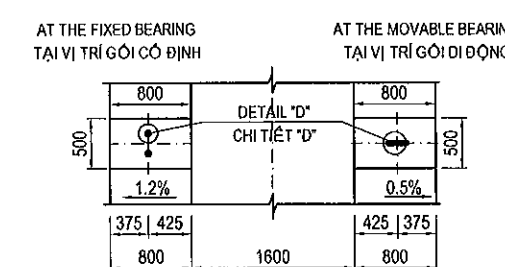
## DETAIL PIER CAP - CHI TIẾT XÀ MŨ TRỤ
